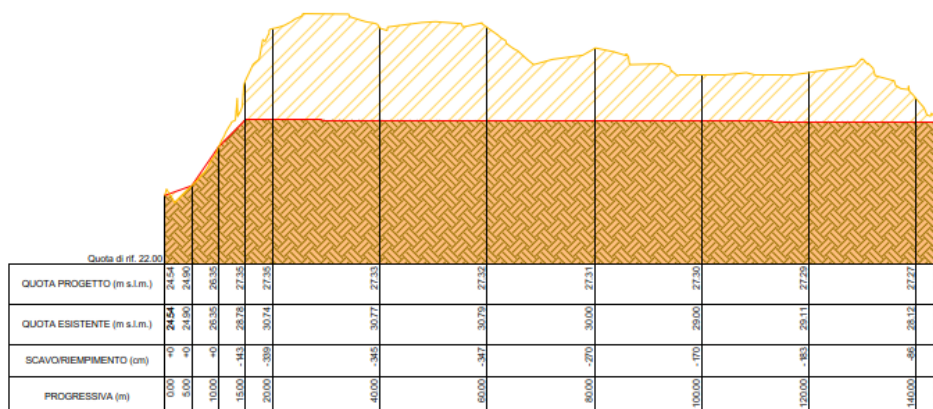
Profilo longitudinale di progetto del canale. Estratto della tavola PF.0.2.7.PR.GE.S.Z.0.0.2.A.
